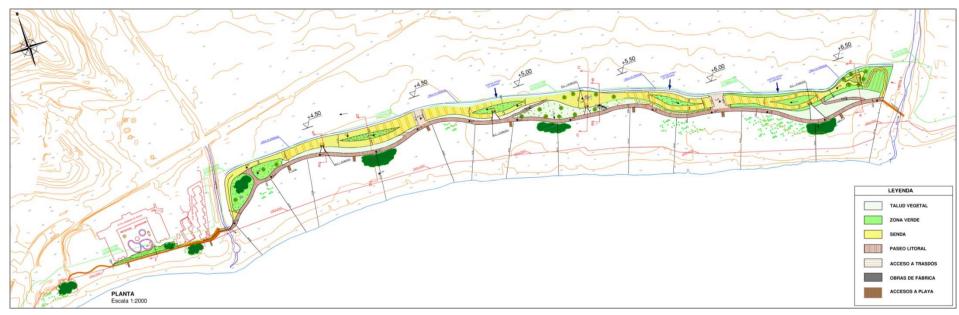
Planta General del Paseo Marítimo de El Playazo proyectado en la Alternativa 2.
